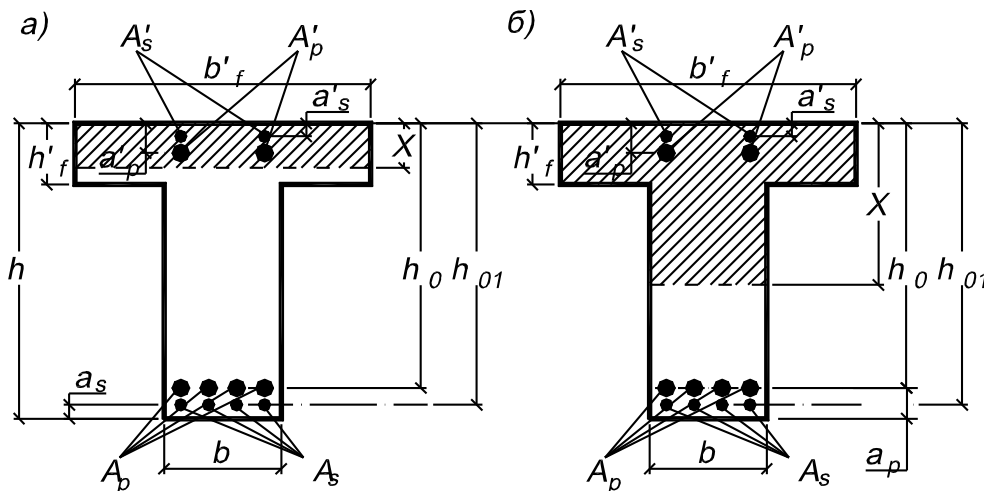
Форма стиснутої зони в перерізах залізобетонних елементів із плитою в стиснутій зоні
